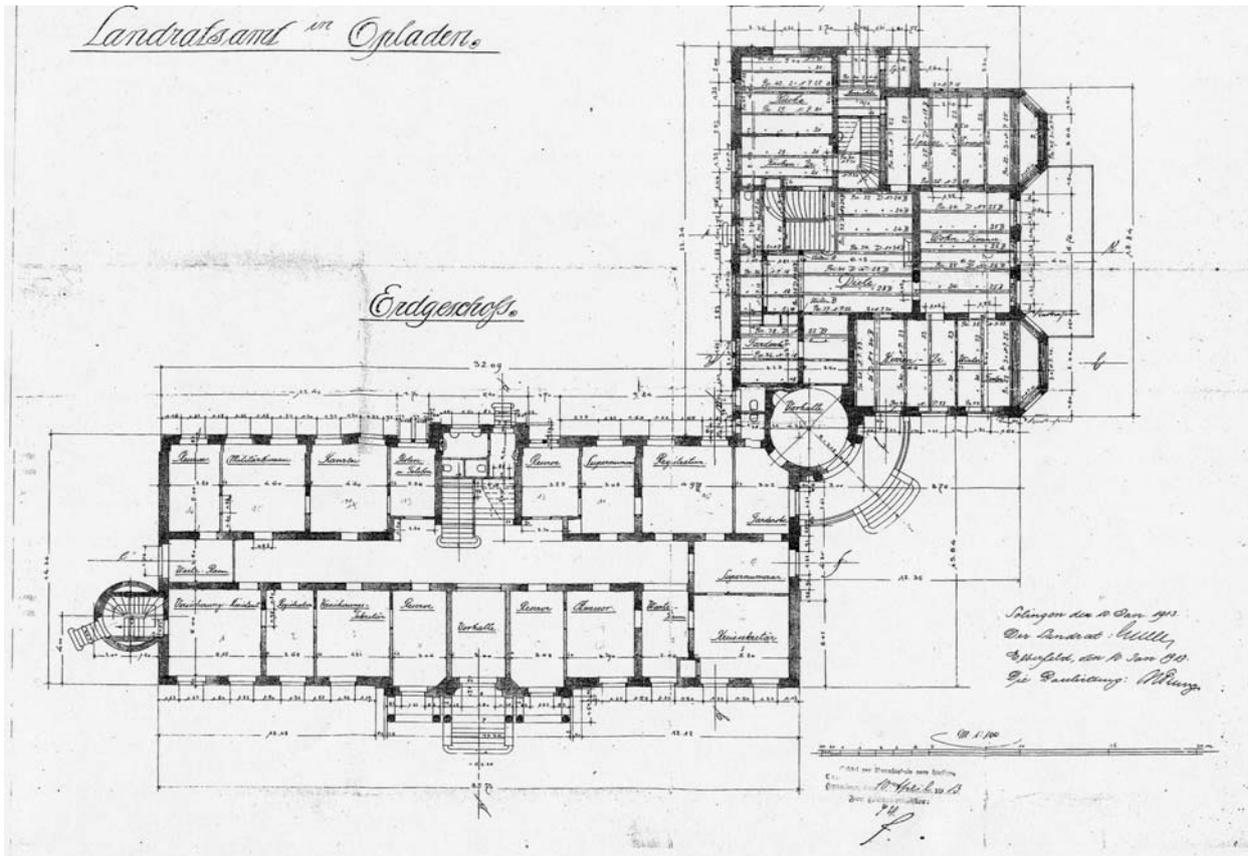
H. Plange, Grundriss Erdgeschoss des Landratsamtes Opladen, 1913
